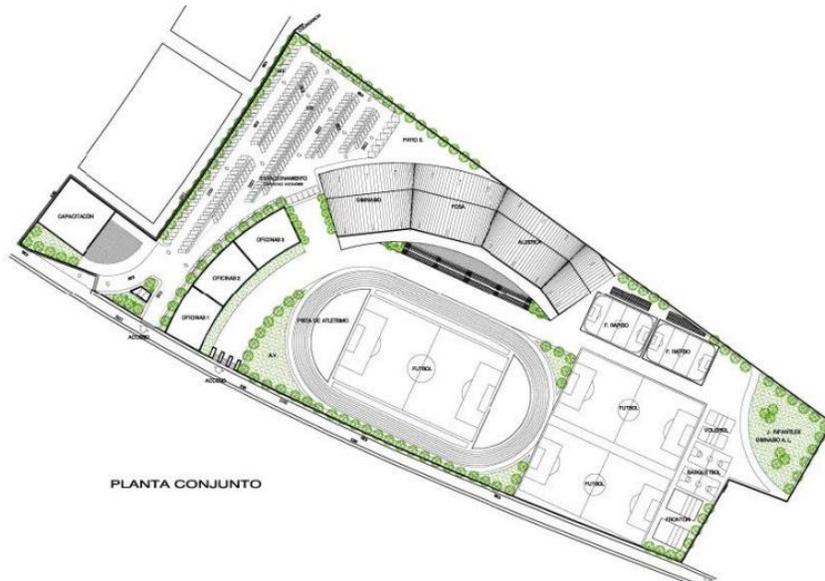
Planta De Conjunto Centro Deportivo la Paz
